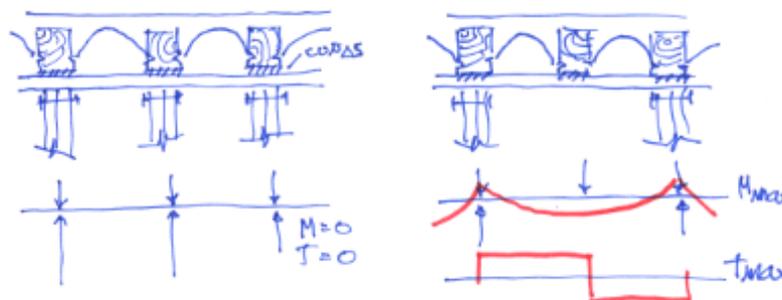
Distancia entre pies derechos con sopanda de tablón plano.
